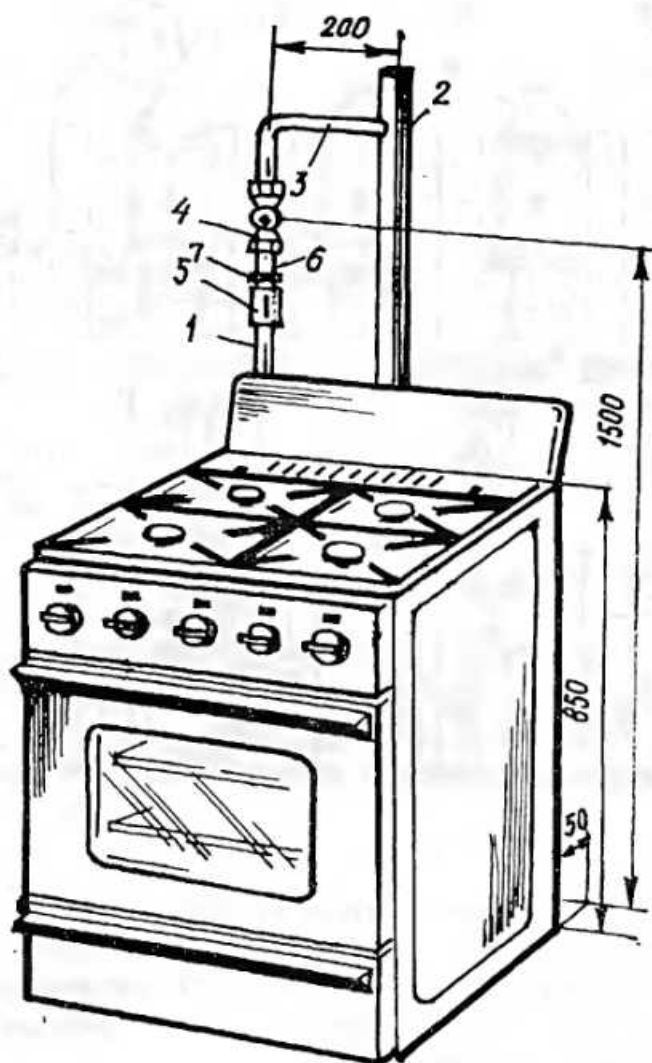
Монтажне положення газової плити: 1-опуск; 2 - стояк; 3 - підводка; 4 - кран; 5- муфта; 6 - згин ; 7- контргайка
